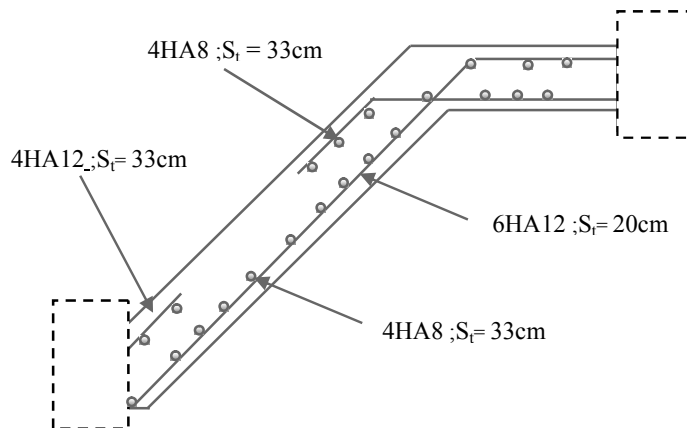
Schéma de ferrailage de l'escalier type (I).
